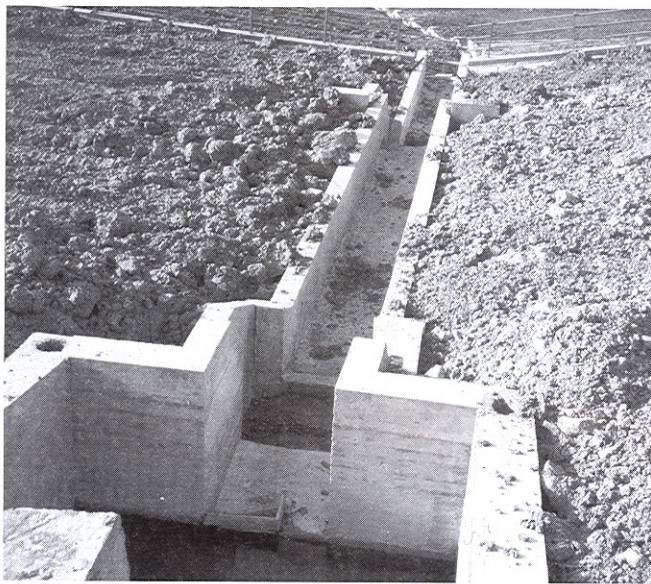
Sistema de zanjas de drenaje en «espina de pez» sobre una ladera inestable en el norte de Italia (foto M. Ferrer).
